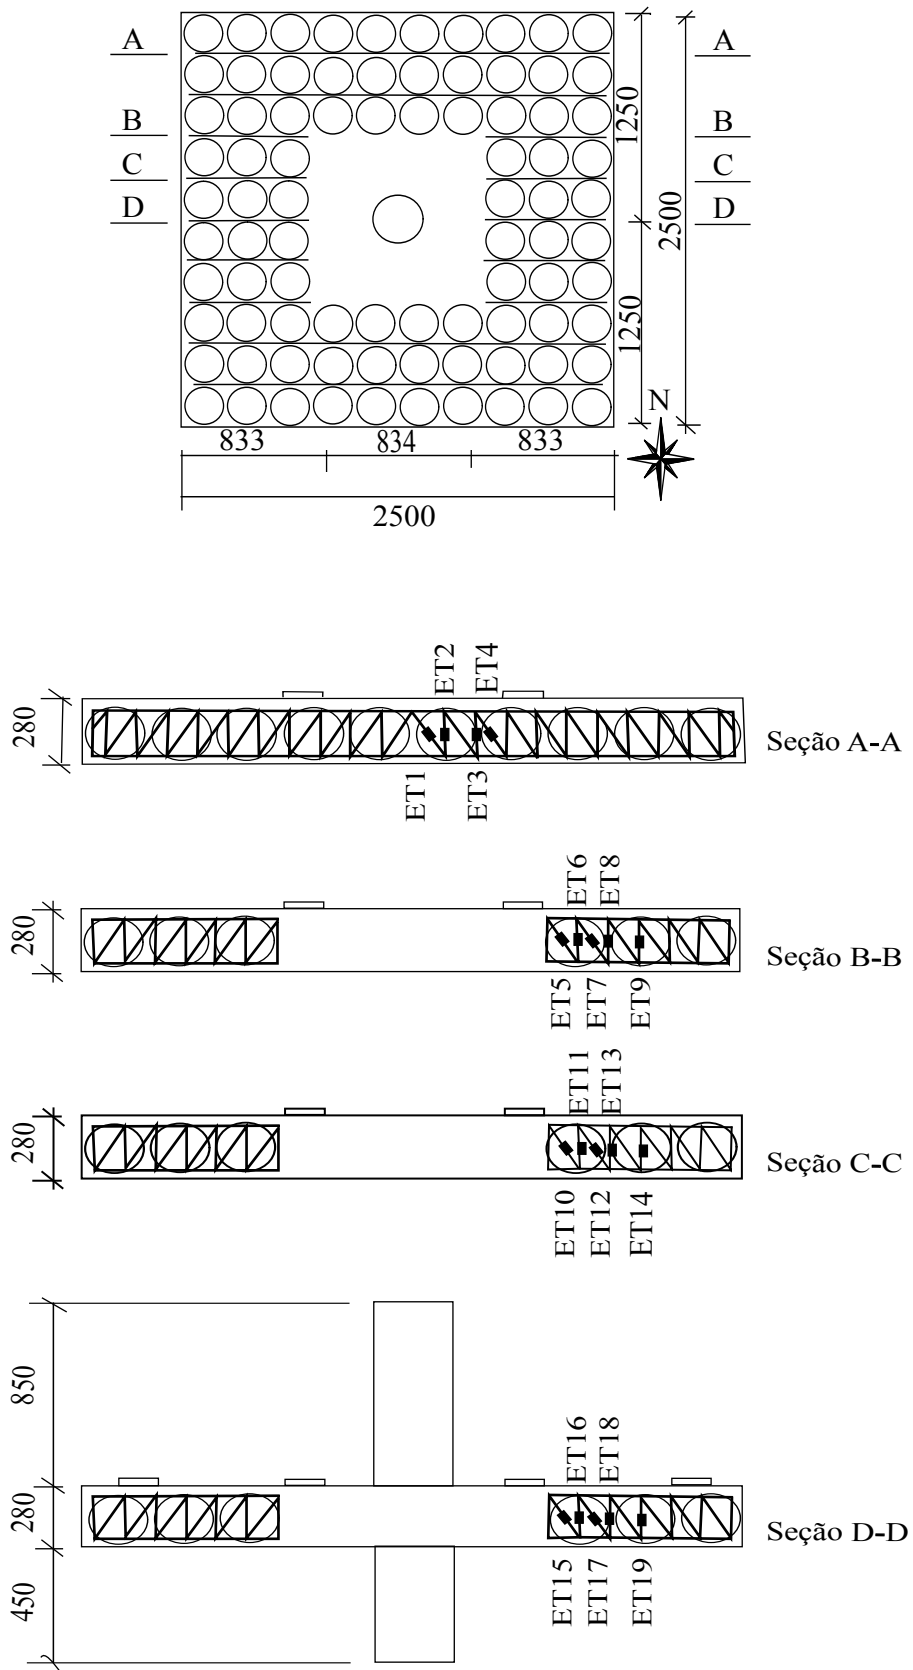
Posicionamento dos extensômetros nas treliças da laje BD-A04
